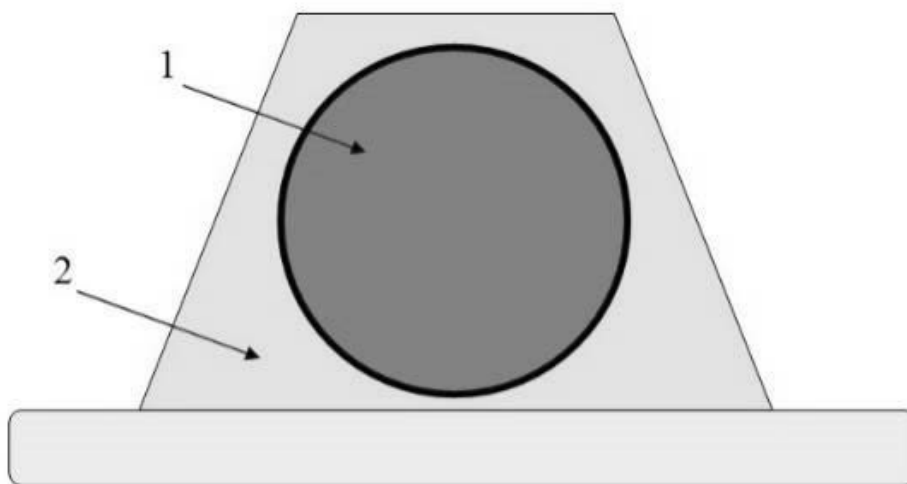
Наземный трубопровод: 1 – трубопровод; 2 – грунтовая подушка и внешняя обсыпка грунтом
